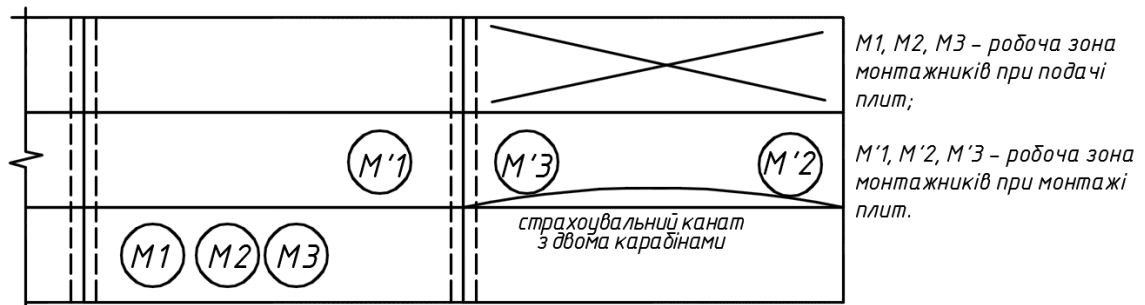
Розташування монтажників при монтажі та подачі плит
